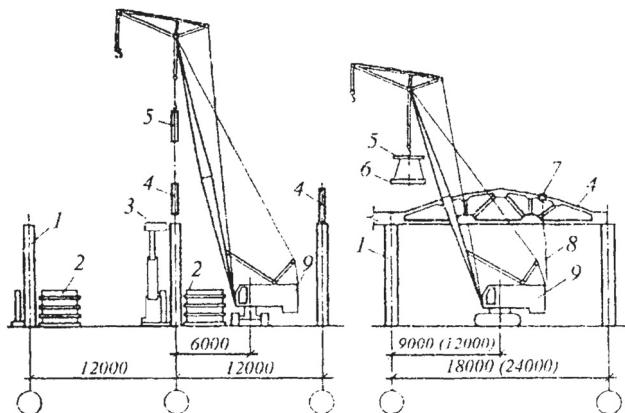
Схемы монтажа ферм пролетом 18 и 24 м и плиты покрытия поперечным методом:
